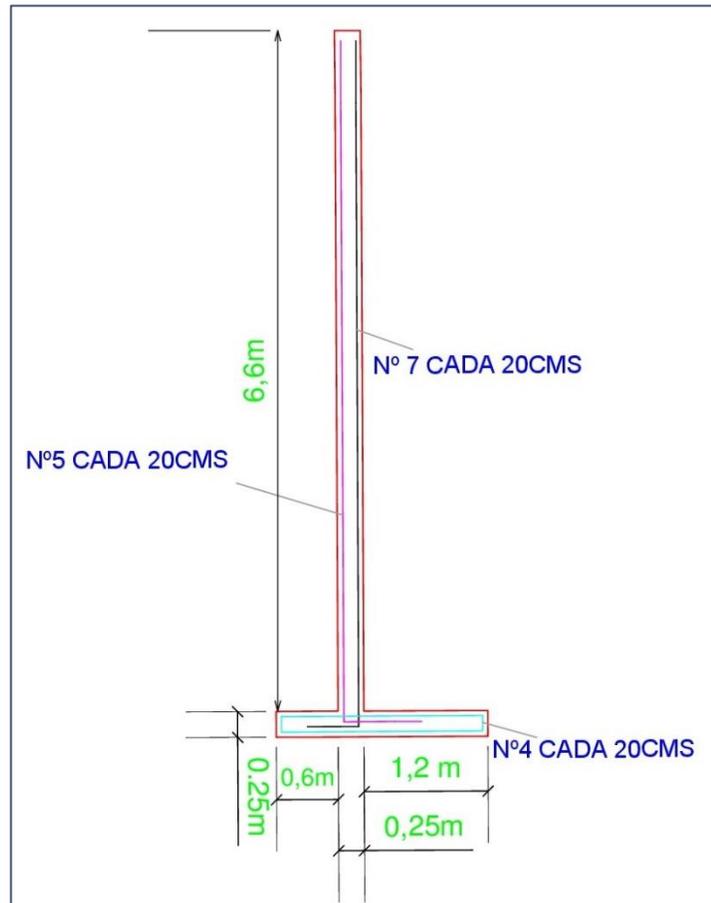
Detalle despiece muro de contención. Fuente propia
